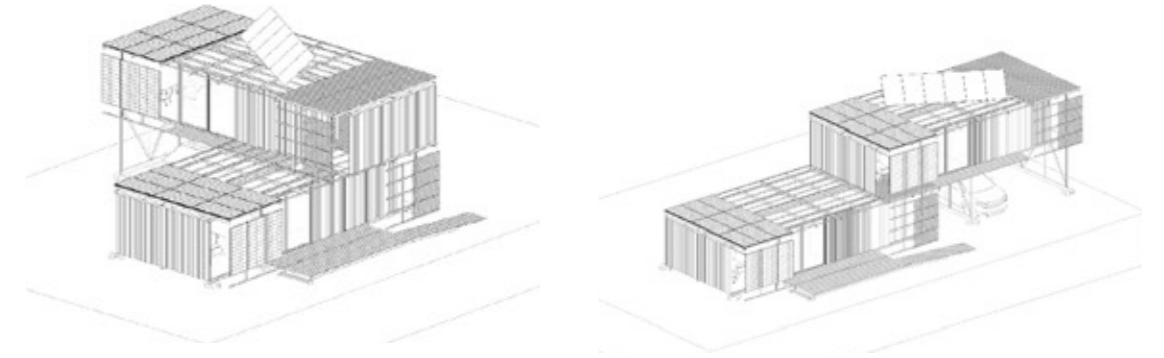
Diagramas de articulación y agrupación de la vivienda energética, con adición de módulo en segundo piso. Fuente: J. Guerra.
